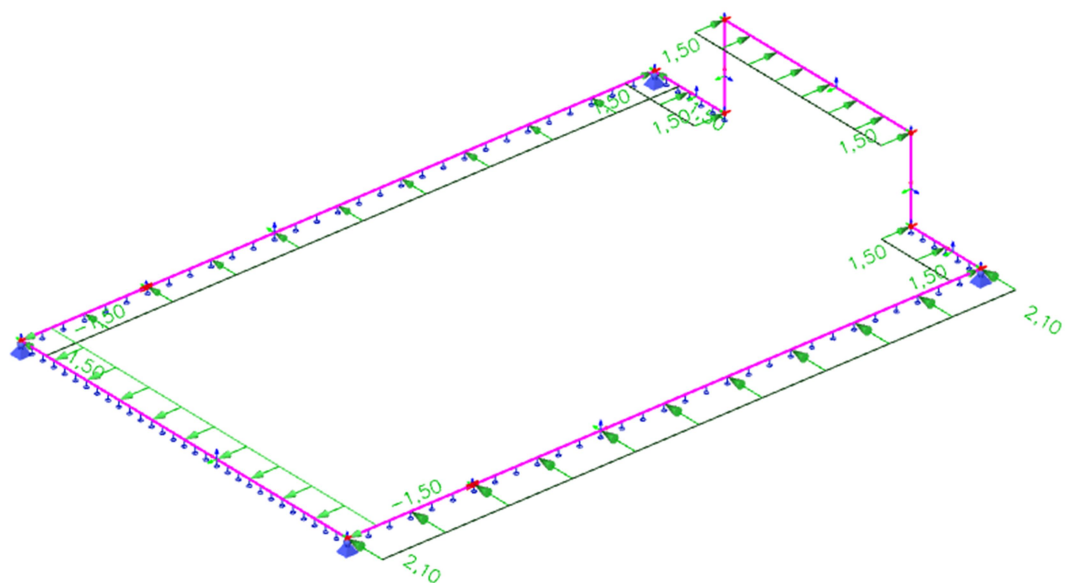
Konstrukce 3, Zatěžovací stav ZS2
